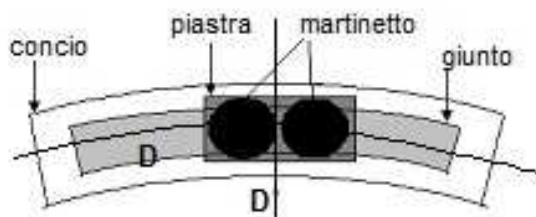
Applicazione della spinta sul giunto longitudinale – piani D e D' di armatura
